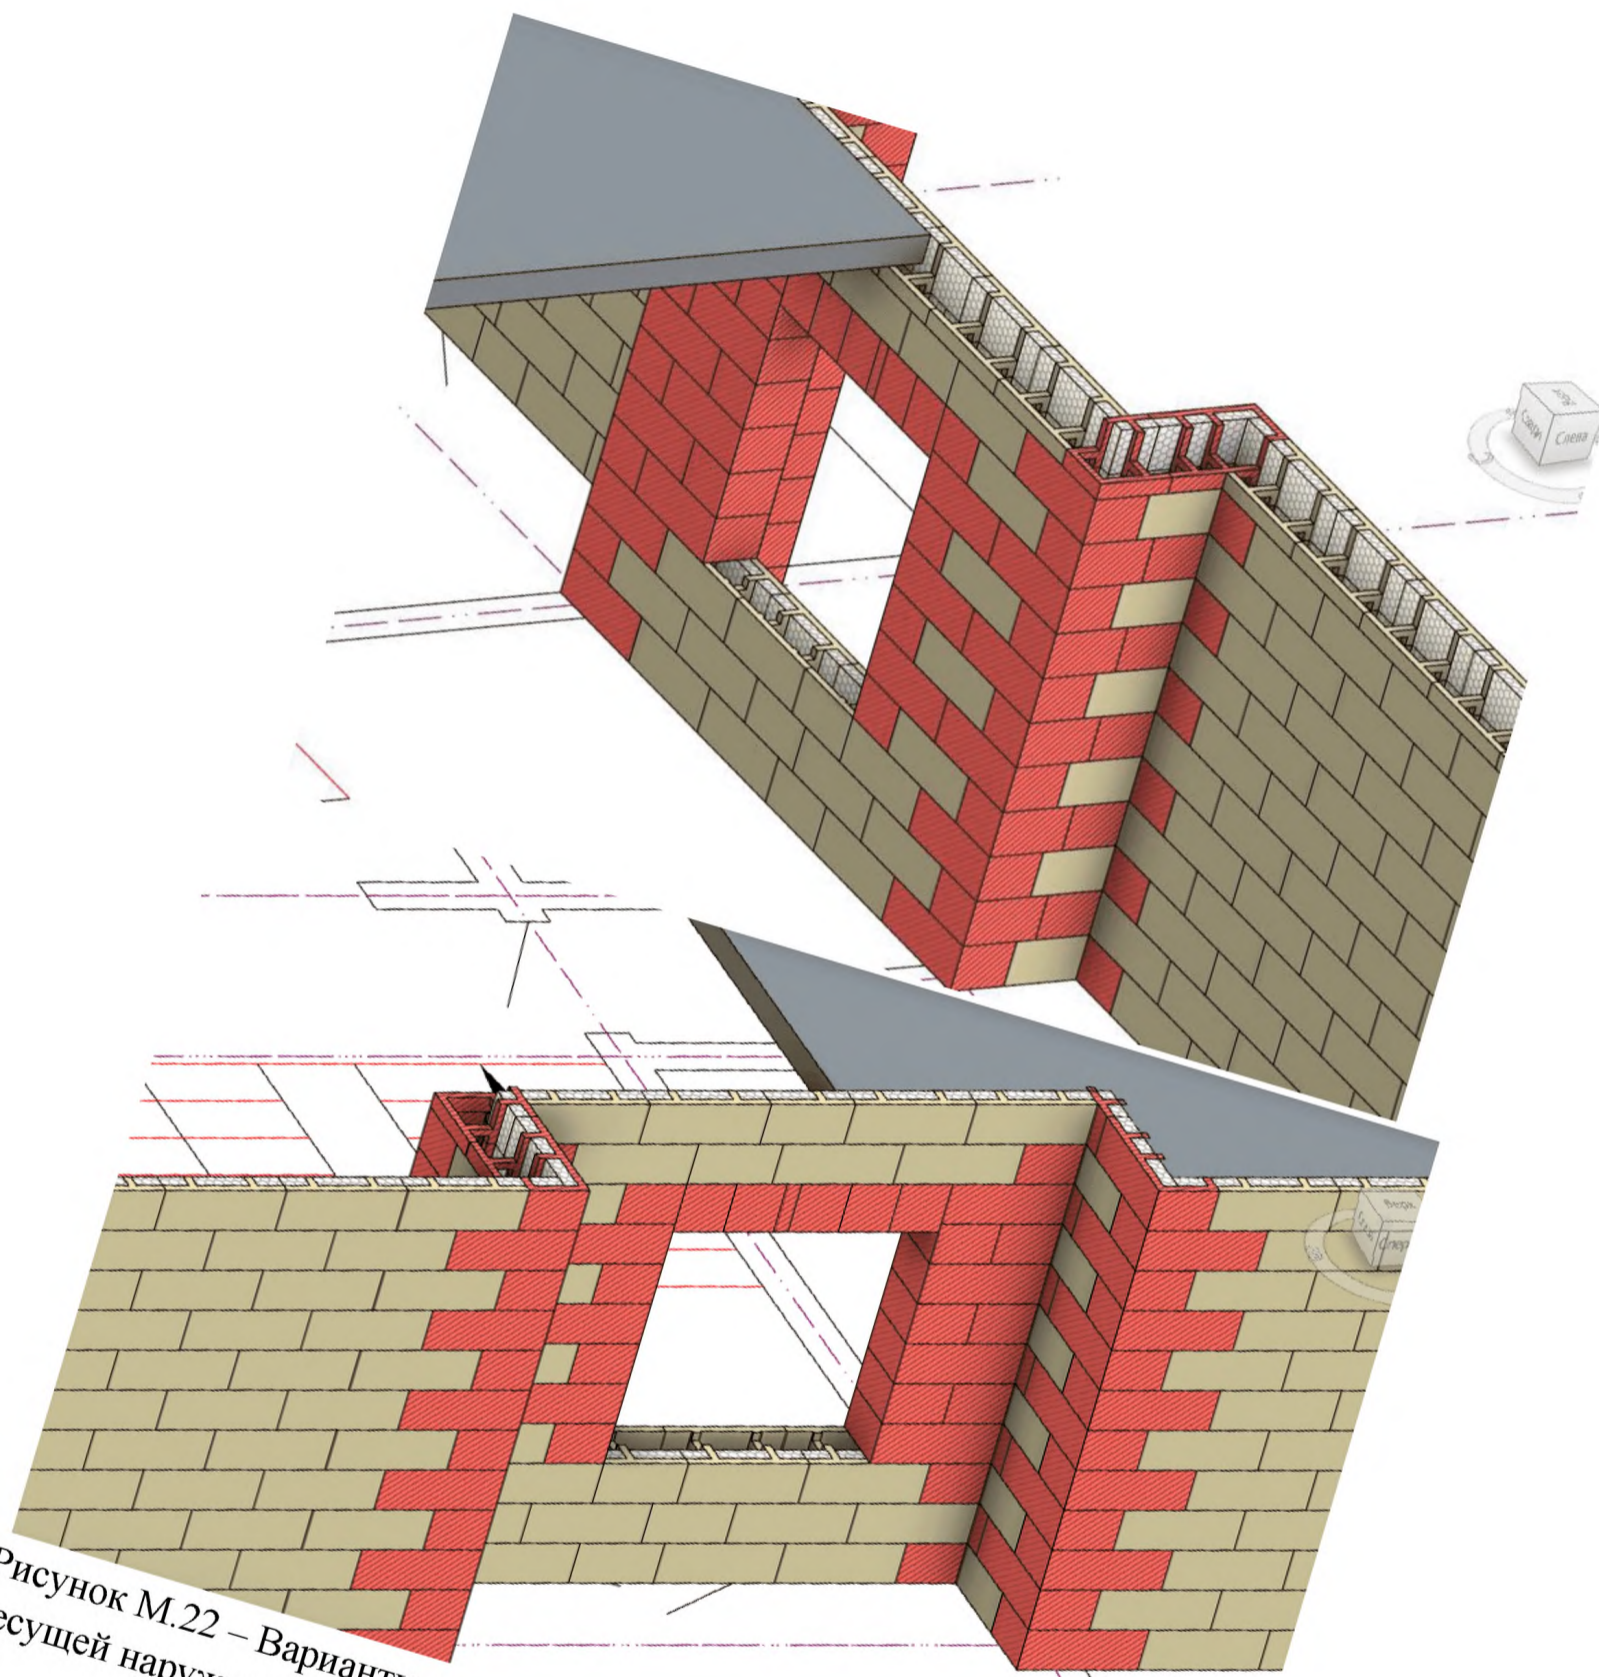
Варианты сопряжения монолитного перекрытия с кладкой несущей наружной стены на участках с выступающей ее частью с оконным проемом
